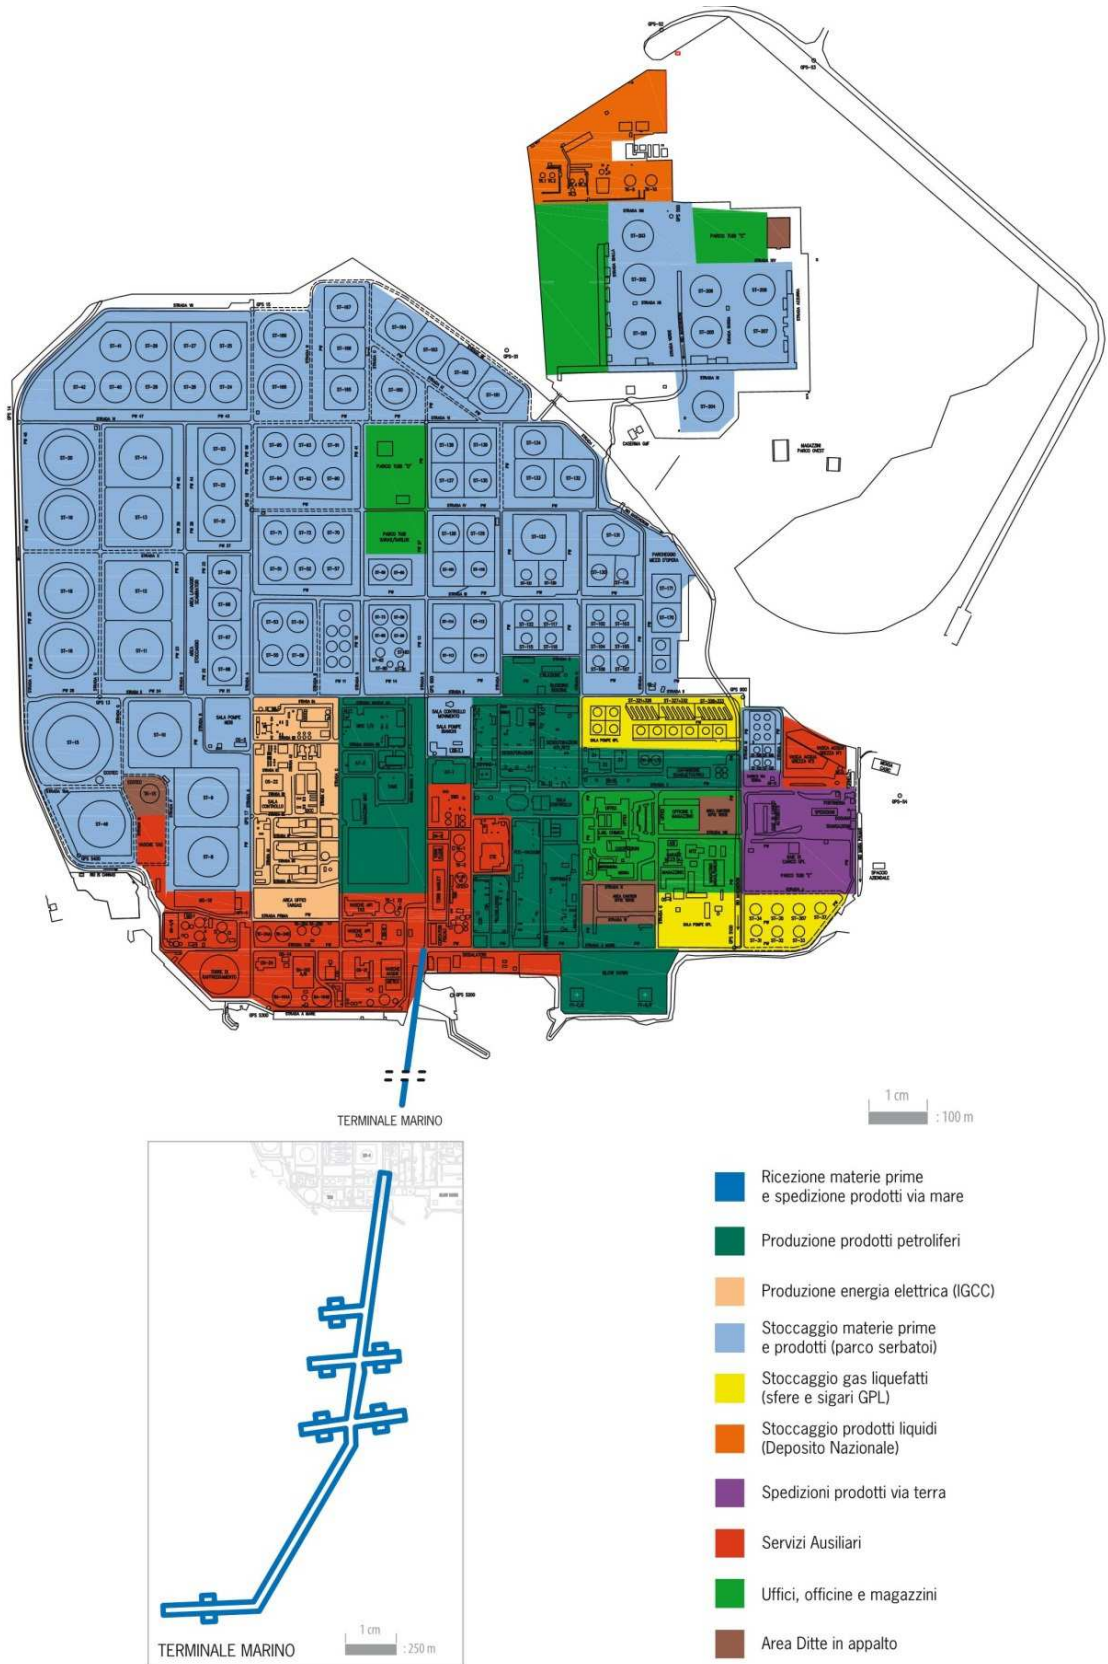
Planimetria generale dello stabilimento Sarlux – Area Impianti Sud
